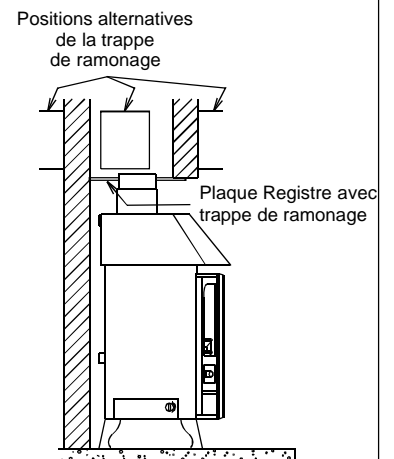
Plaque Registre Horizontal avec branchement au conduit par dessus
